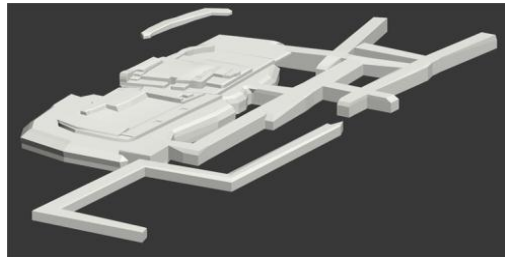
Detalles del Modelado Baños del Inca III
